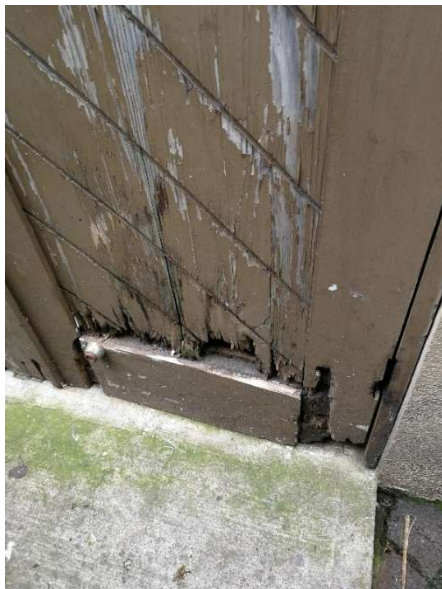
, 85, Estado de Puertas en Fachadas, Fuente: Arq. Jorge Omar Vega Rosales
